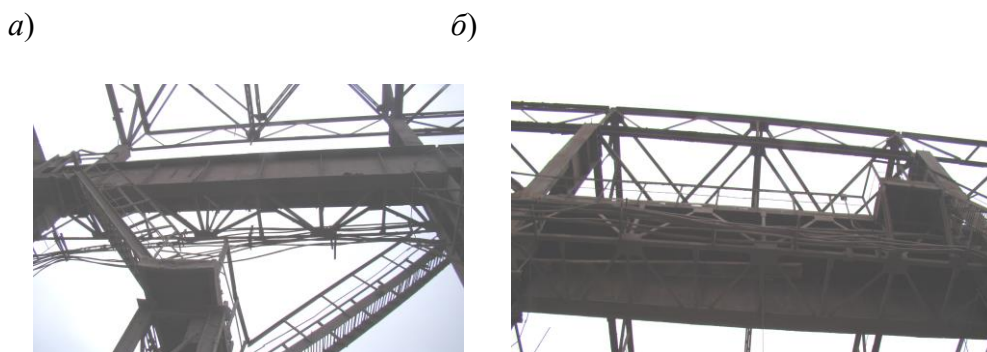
Связевая (горизонтальная) и тормозная (вертикальная) фермы подкрановых балок (вид снизу)
